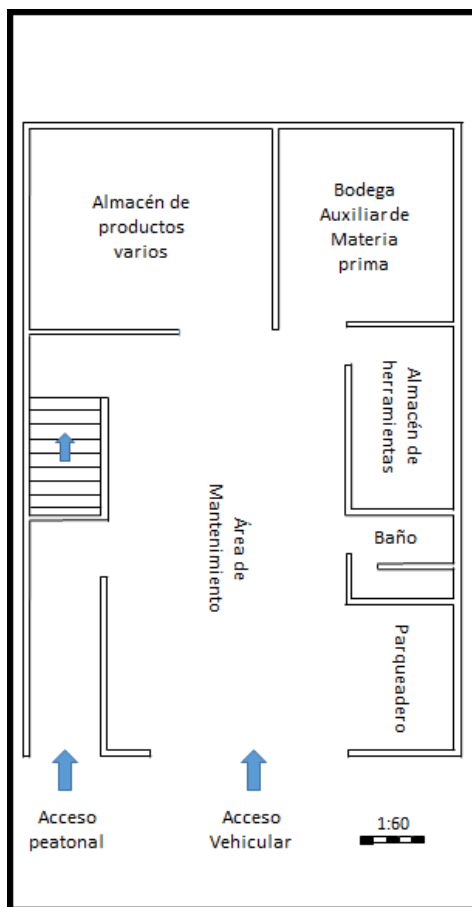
Distribución en planta piso 1 AMASAR. Nota: Autoría propia.
